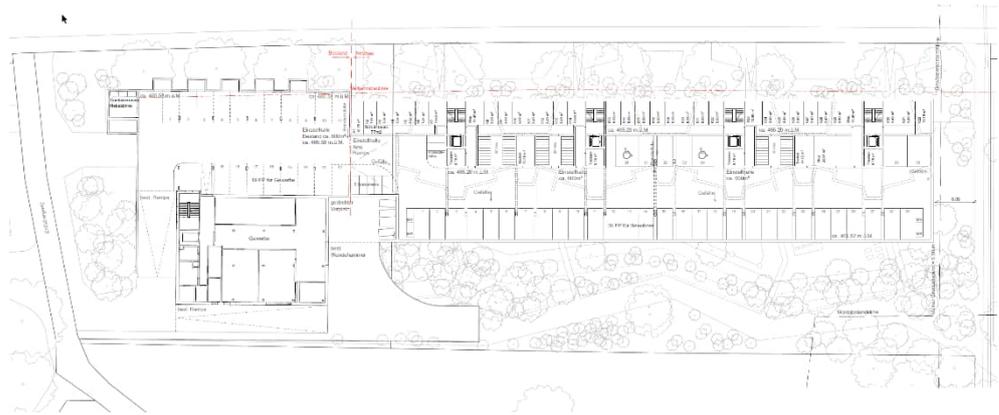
Grundriss UG (Bob Gysin Architekten 2024)
